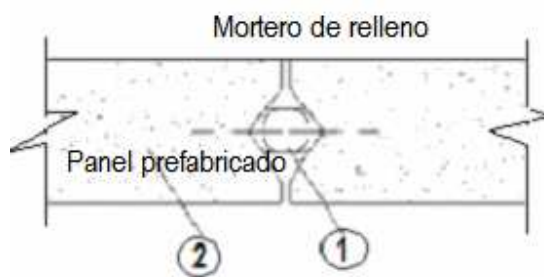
Construcción mixta. Detalle de conexión húmeda frontal. 1- Mortero de relleno, 2-Panel prefabricado de hormigón.
